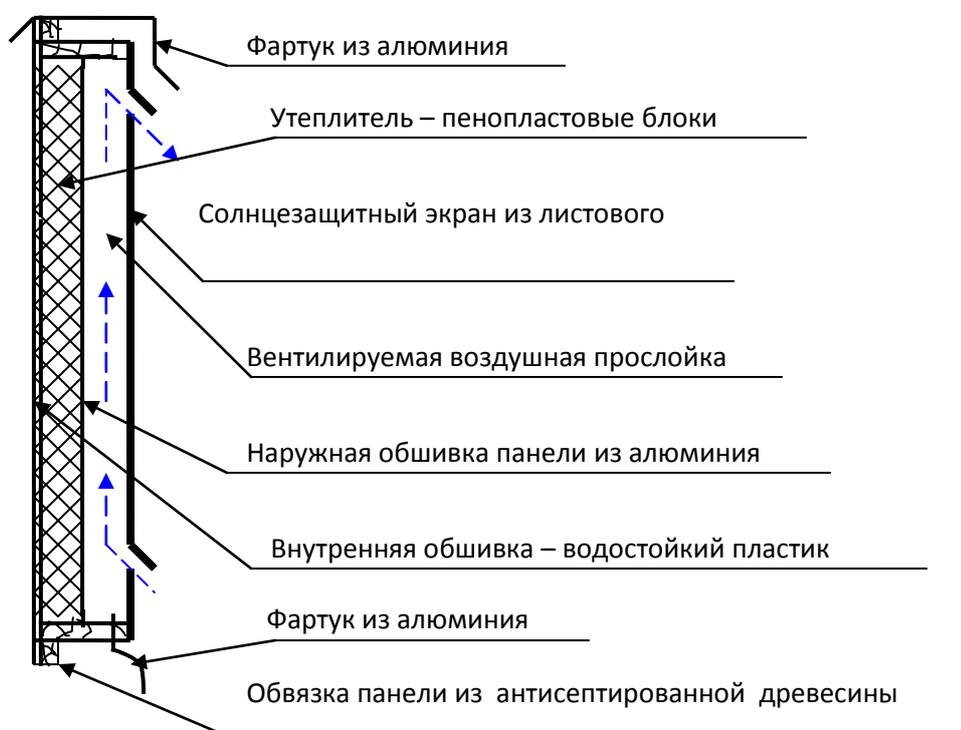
Конструктивное решение стеновой панели с вентилируемой воздушной прослойкой
